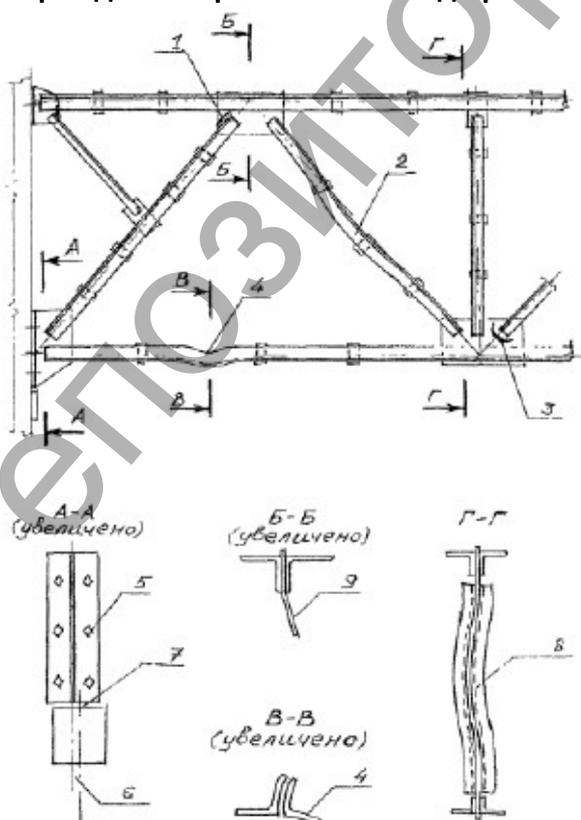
Повреждения стальных стропильных и подстропильных ферм [15]:
